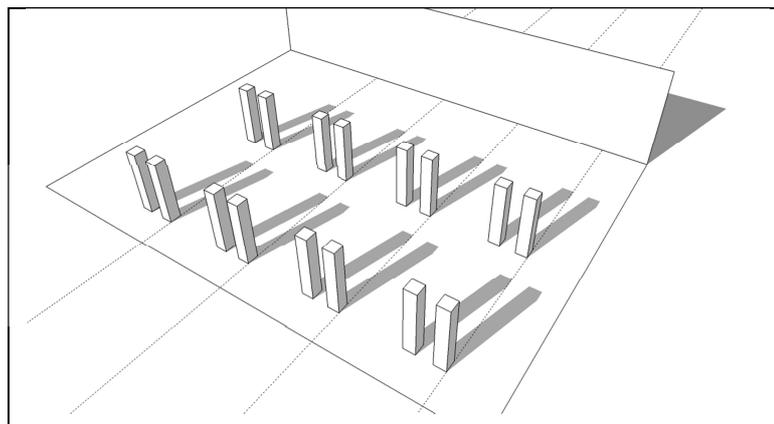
Vista 3D de los dieciséis (16) tabiques de concreto construidos en la sección de vaciado para la colocación de los moldes.
